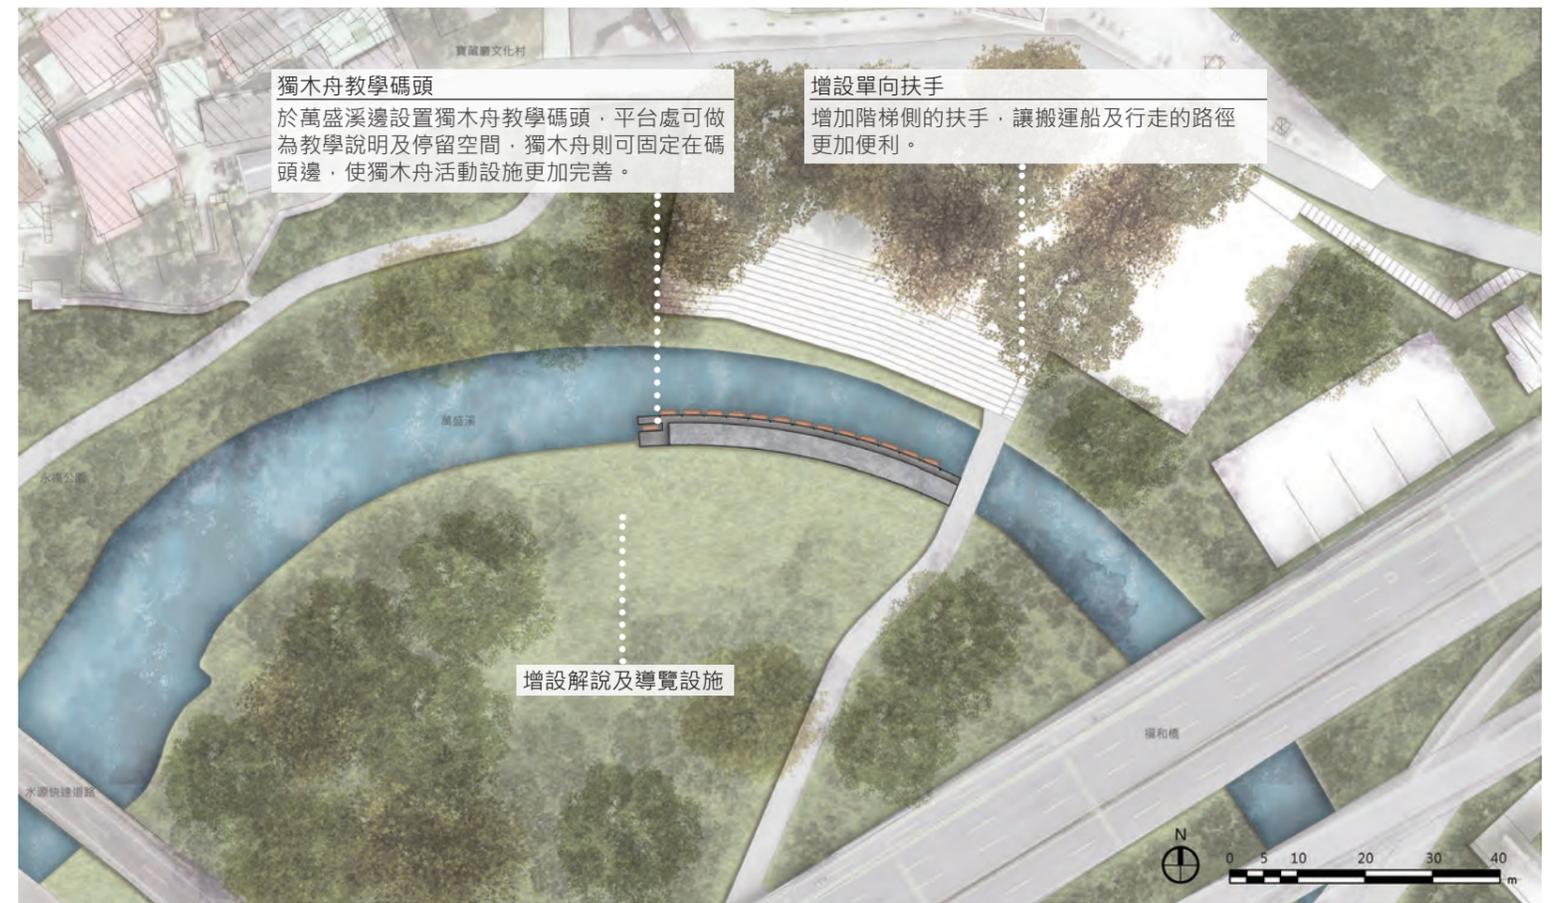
獨木舟碼頭區 - 平面配置設計圖
